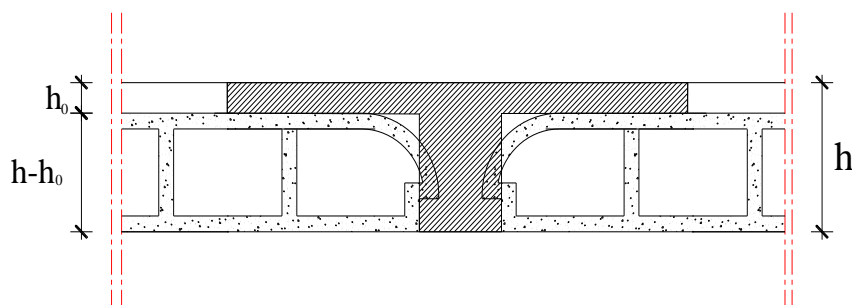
Coupe transversale d'un plancher à corps creux
